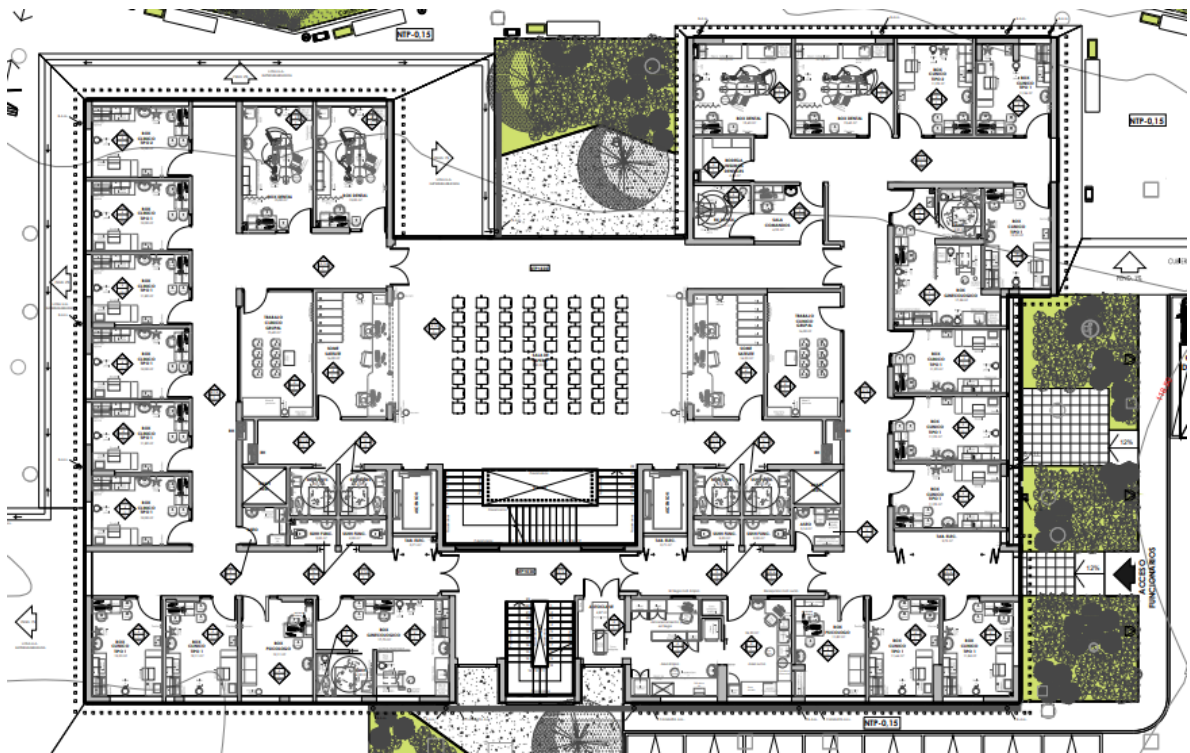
Planta de Segundo Nivel – Enero 2022
